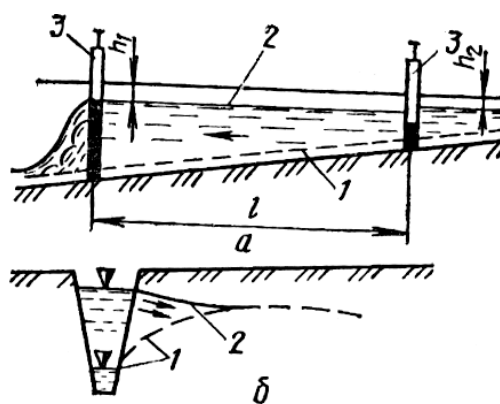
Схема шлюзования канала: а – продольный разрез по оси канала; б – поперечный разрез канала; 1 – уровень воды в канале и грунтовых вод до шлюзования; 2 – то же после закрытия шлюзов; 3 – шлюзы
